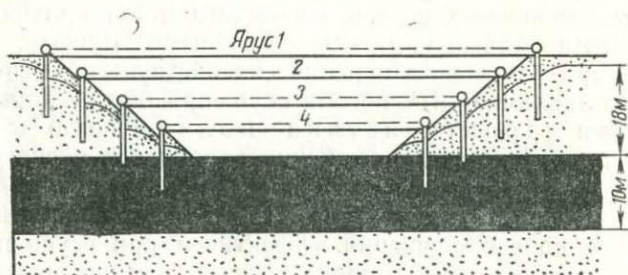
Схема четырехъярусной водопонижающей установки при вскрытии пласта угля
